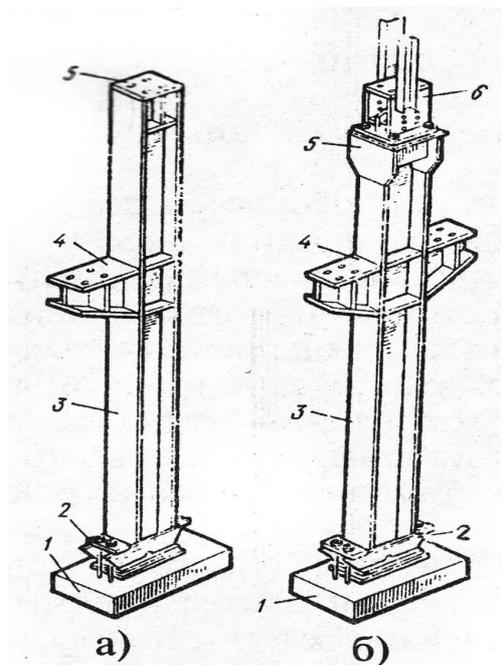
Стальные колонны постоянного сечения для крановых зданий:
